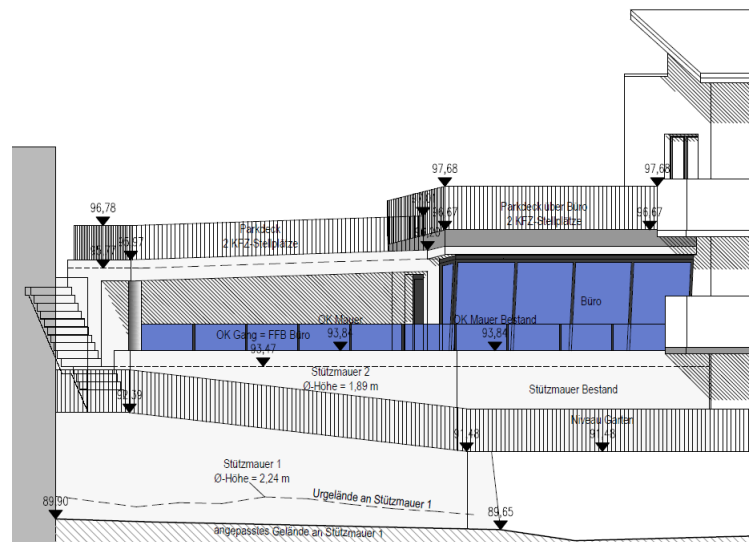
Südansicht des geplanten westlichen Zubauvorhabens am Bestandsgebäude auf der Gp. 947/34 seitens des Planungsbüros R&S Planbau mit der Projektnummer „21-029“ und dem Plandatum 23.03.2022 (ohne Maßstab).
